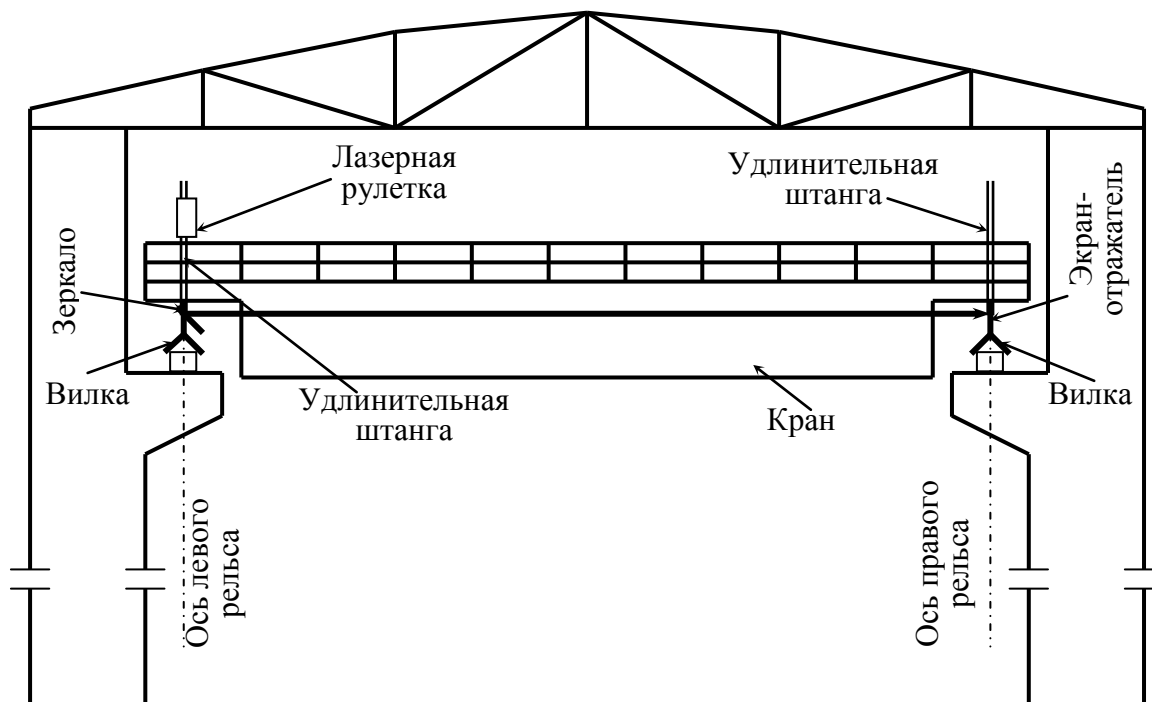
Схема измерения ширины колеи лазерно-зеркальным устройством
